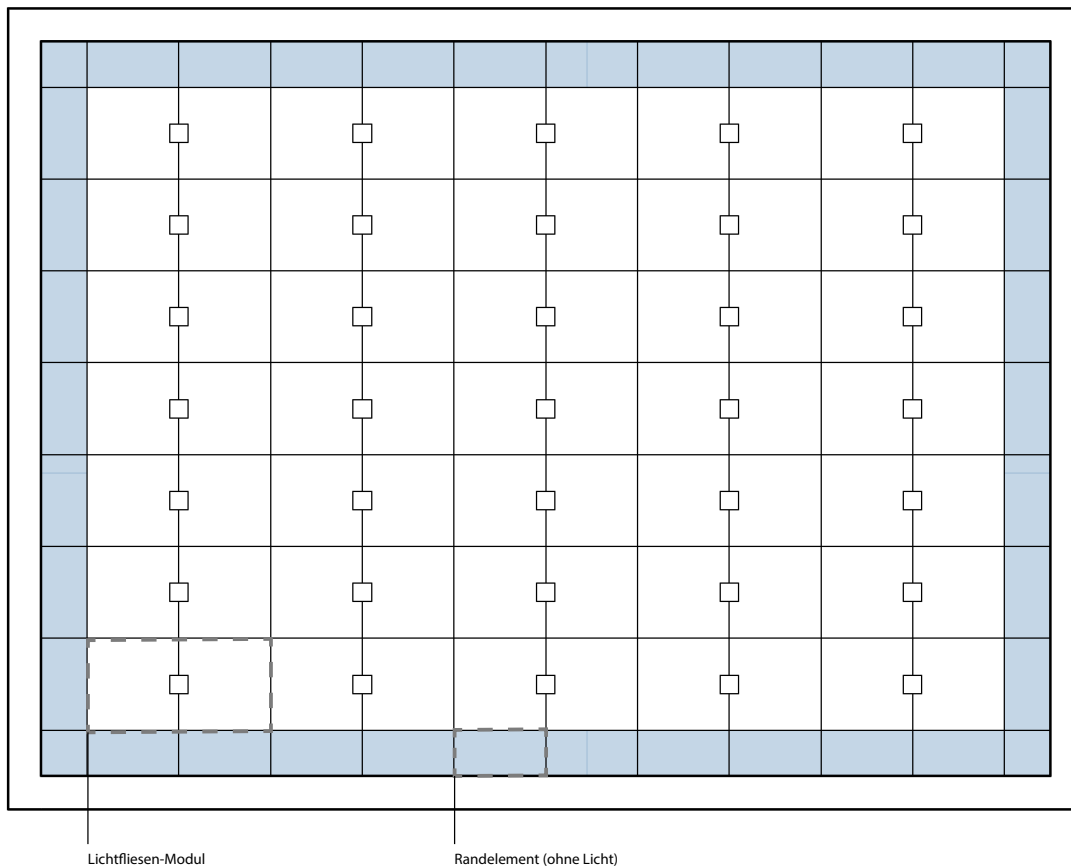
Schematischer Grundriss eines Raumes (mit unvollständigem Metermaß)
